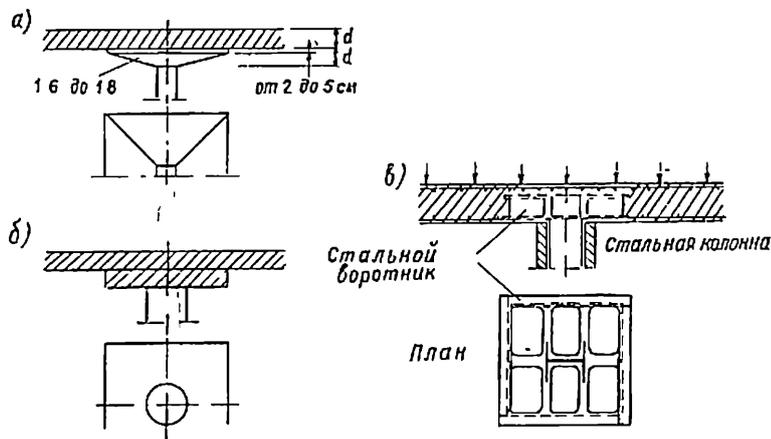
Защита от продавливания, достигнутая утолщением плиты у колонны (а) или с помощью жесткой стальной пластины (б), либо стального воротника (в)
